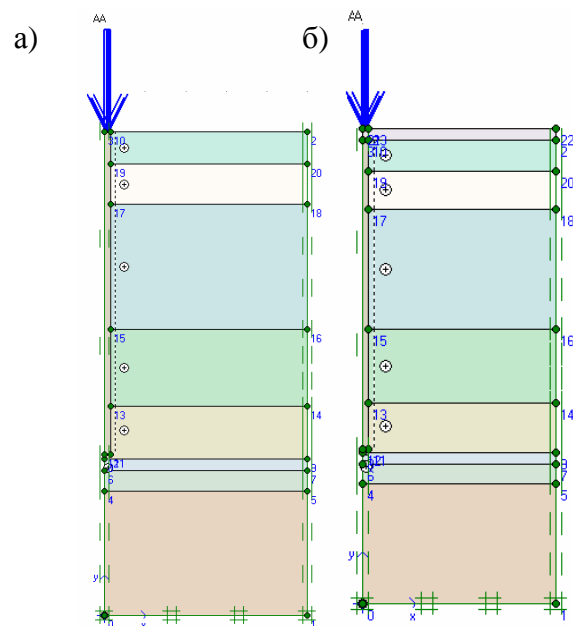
Расчетные схемы а) свая как несущий элемент б) свая как элемент армирования.
